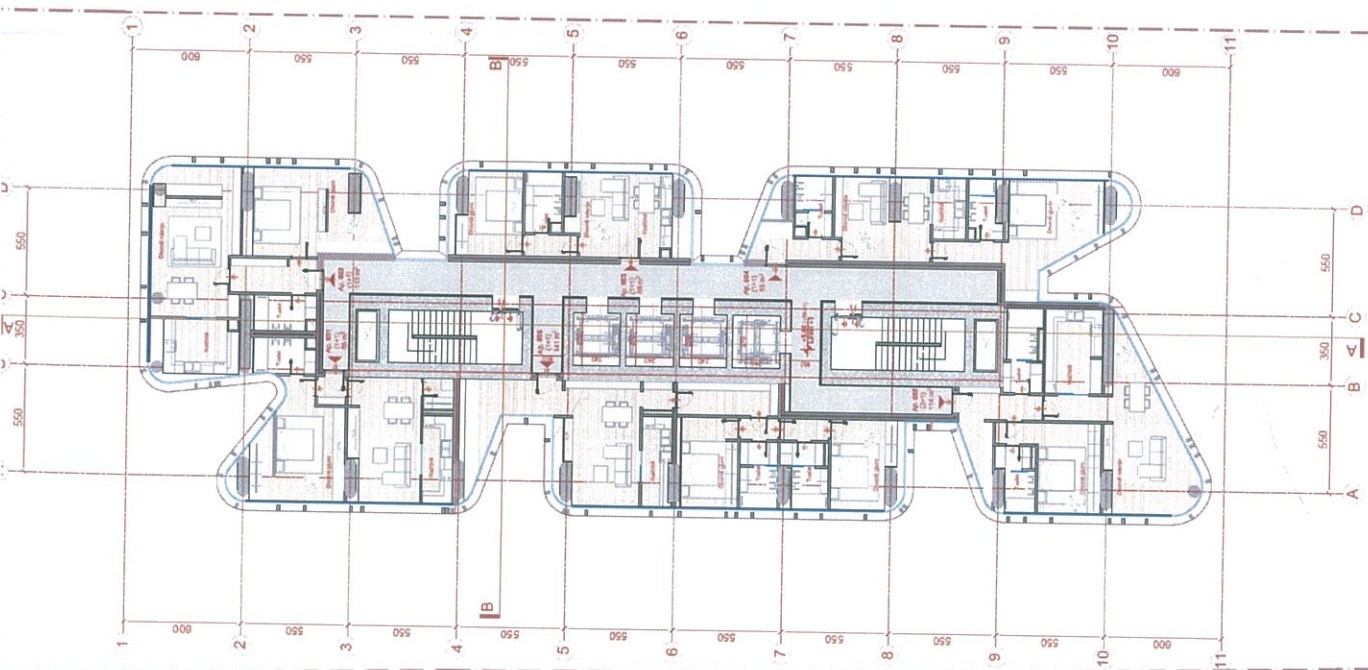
Planimetri e katit të parë (Apart-Hotel).
